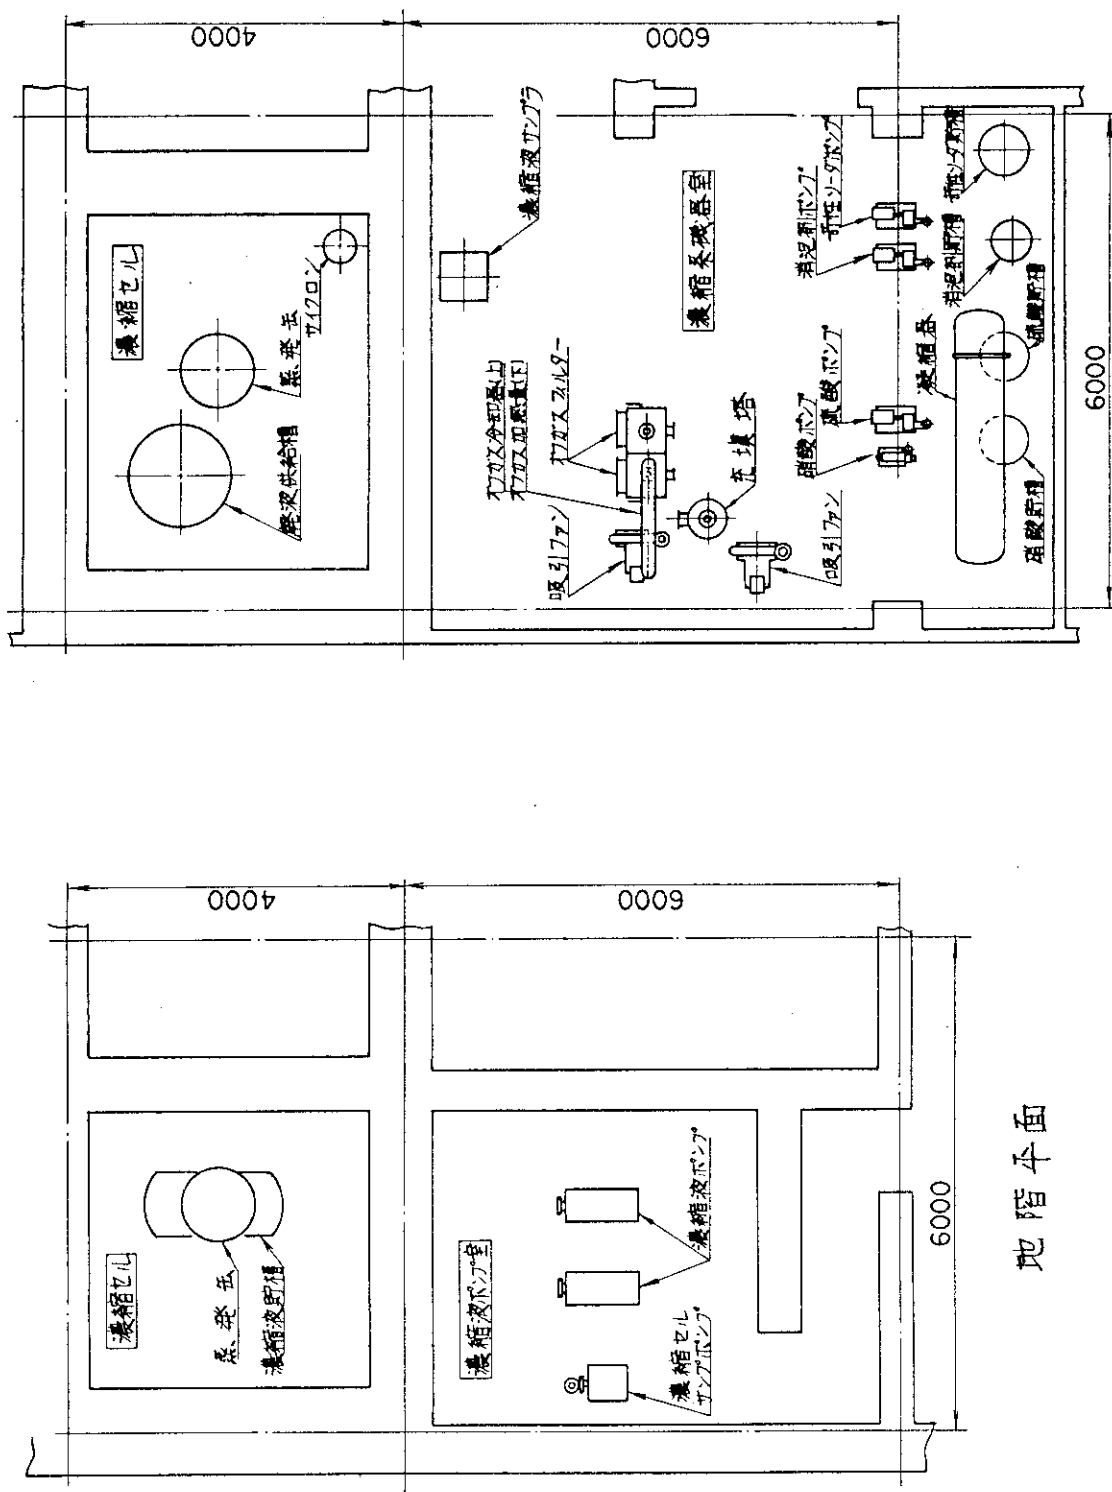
蒸発処理設備機器配置図 (その1) 地階平面
